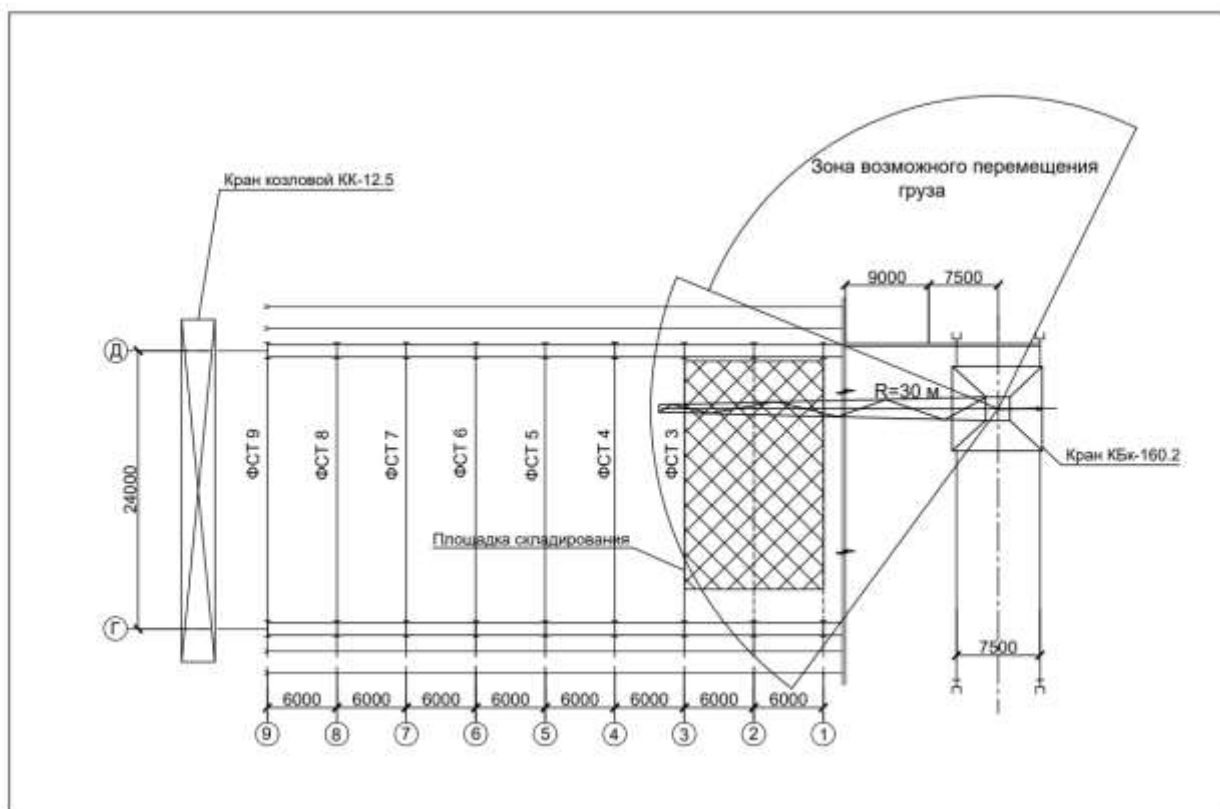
Производство работ при монтаже металлических ферм с помощью крана КБк-160.2
